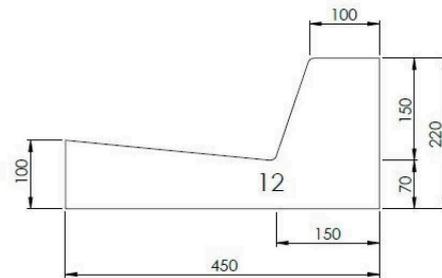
Fonte: Site da Pavimak - Máquinas extrusoras
